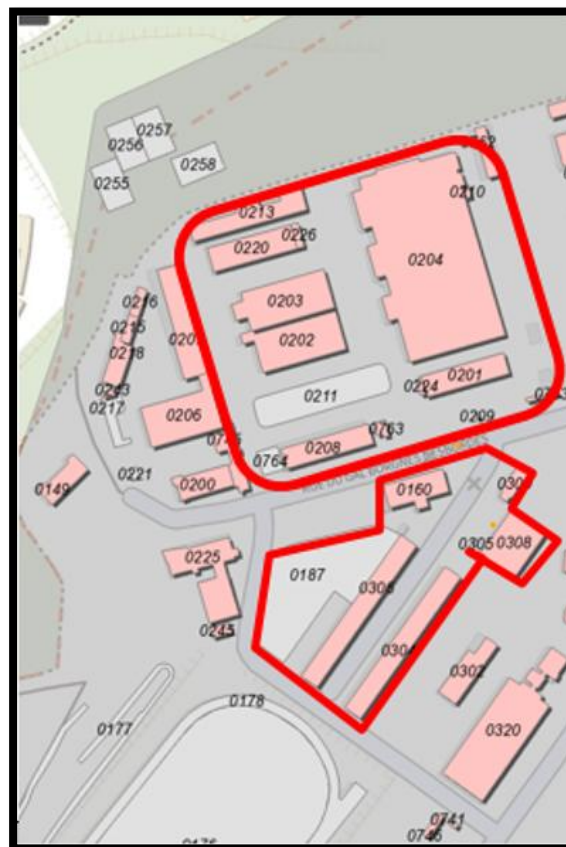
vue en plan de la zone technique avec identification des bâtiments existants sur l'emprise
